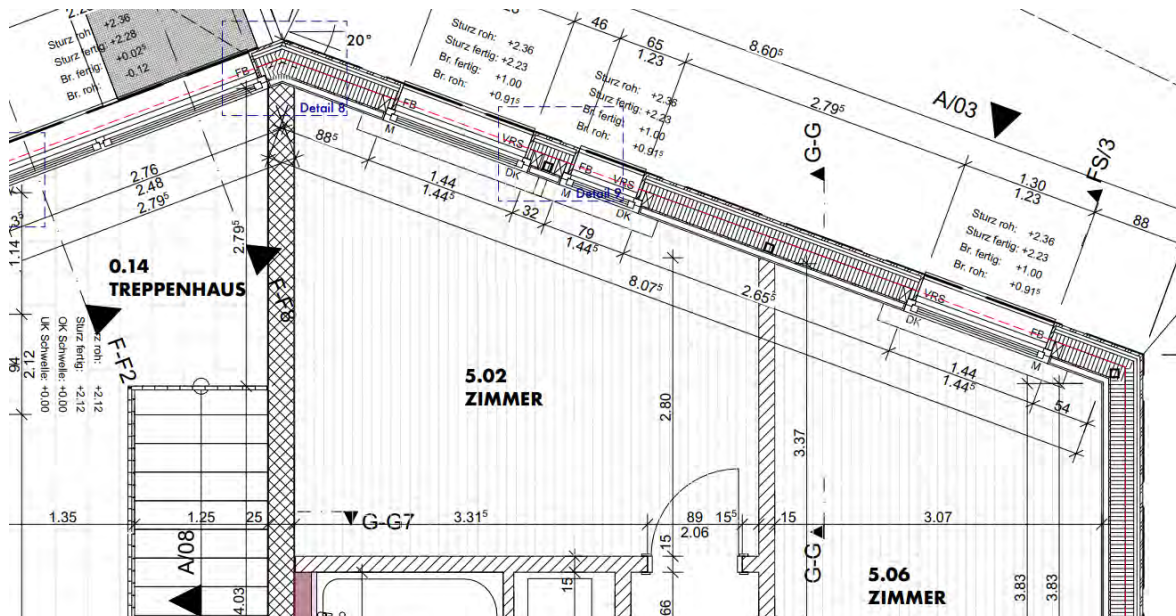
Planausschnitt des Erdgeschosses. Zu sehen ist die Aussenwandkonstruktion in Holzbauweise mit der innersten Installationsebene. Die Dampfbremse wird durch die OSB-Platte auf der Innenseite der Dämmung sichergestellt. Das Gebäude erhält seinen Charakter durch den Grundriss mit Aussenecken in stumpferen Winkeln als die gängigen 90°. Die Strohbauplatten hätten problemlos für die Beplankung verwendet werden können. Die Anschlüsse der inneren Trennwände sind hier noch falsch dargestellt. Die Beplankung der Aussenwände wurde bei den inneren Trennwänden getrennt, was für den nötigen Schallschutz zwischen den Räumen sorgt
